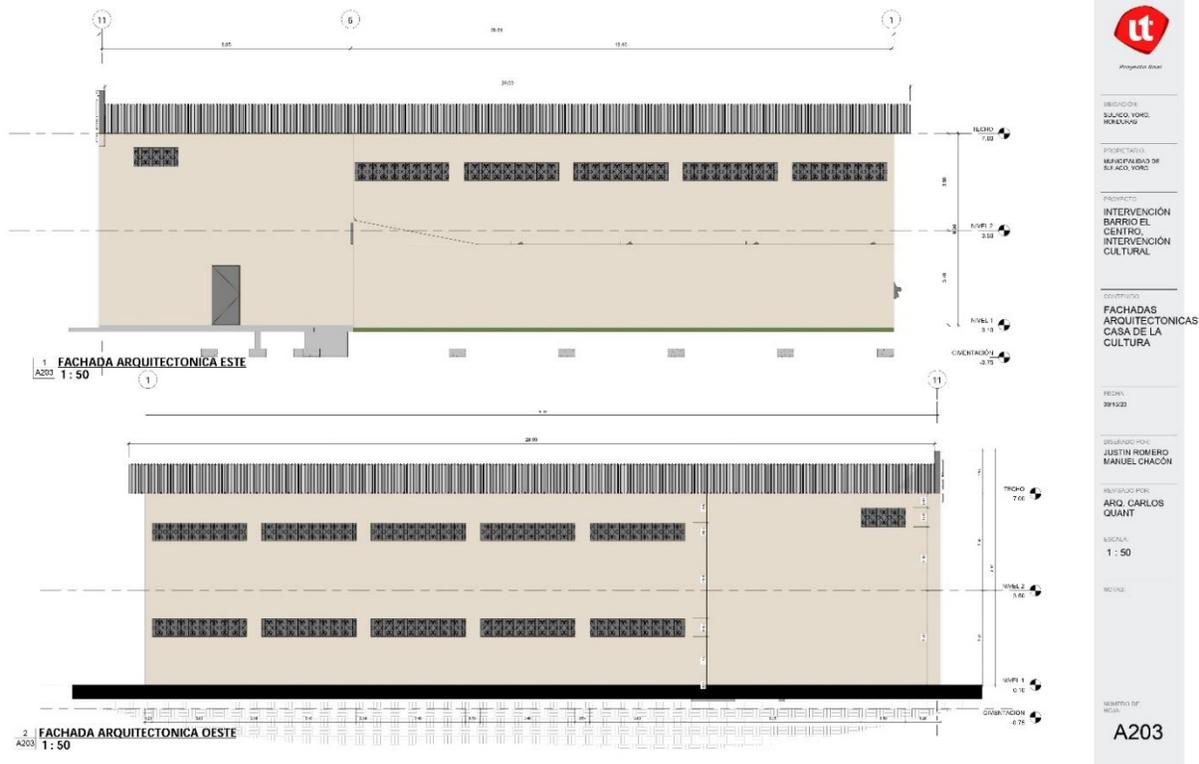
Fachadas Propuesta | Fuente: Elaboración Propia
